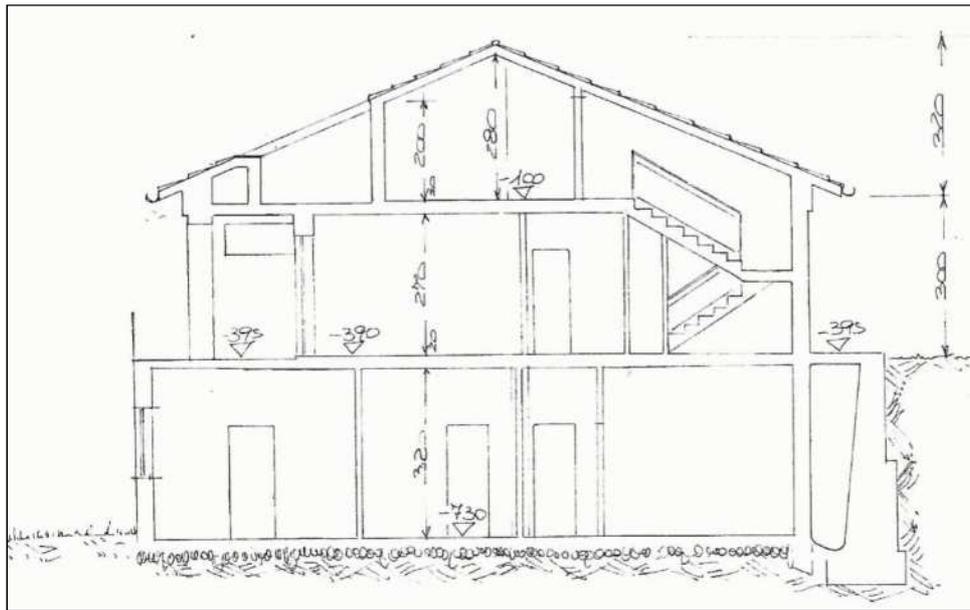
SEZIONE DELLA PALAZZINA VISTA DA EST
